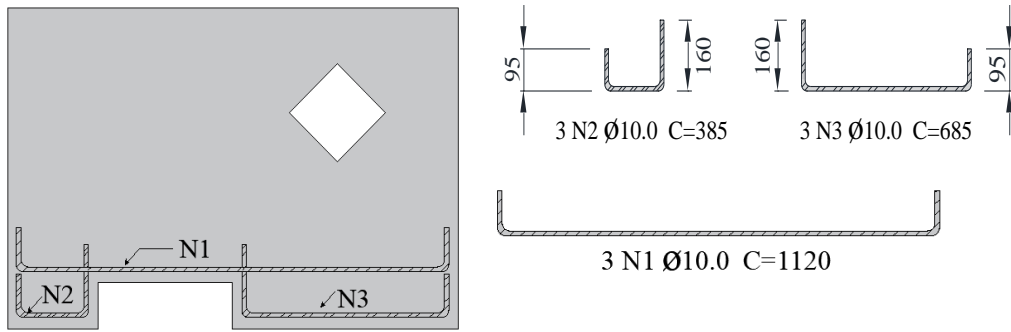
Detalhamento das armaduras DB2-H1-U-A (dimensões mm)
